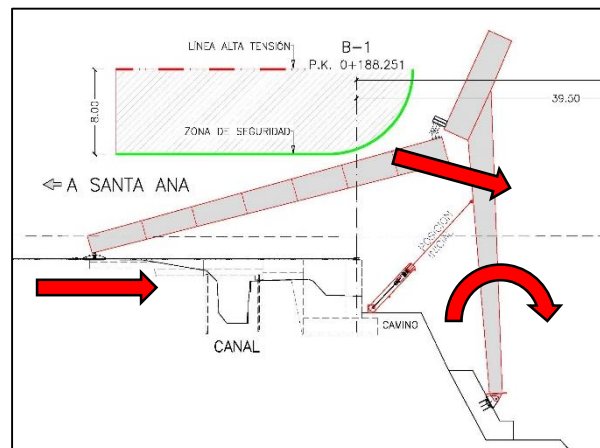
Situación de abatimiento de pilas y traslación+giro del tramo 1 del tablero del proceso constructivo del proyecto original
